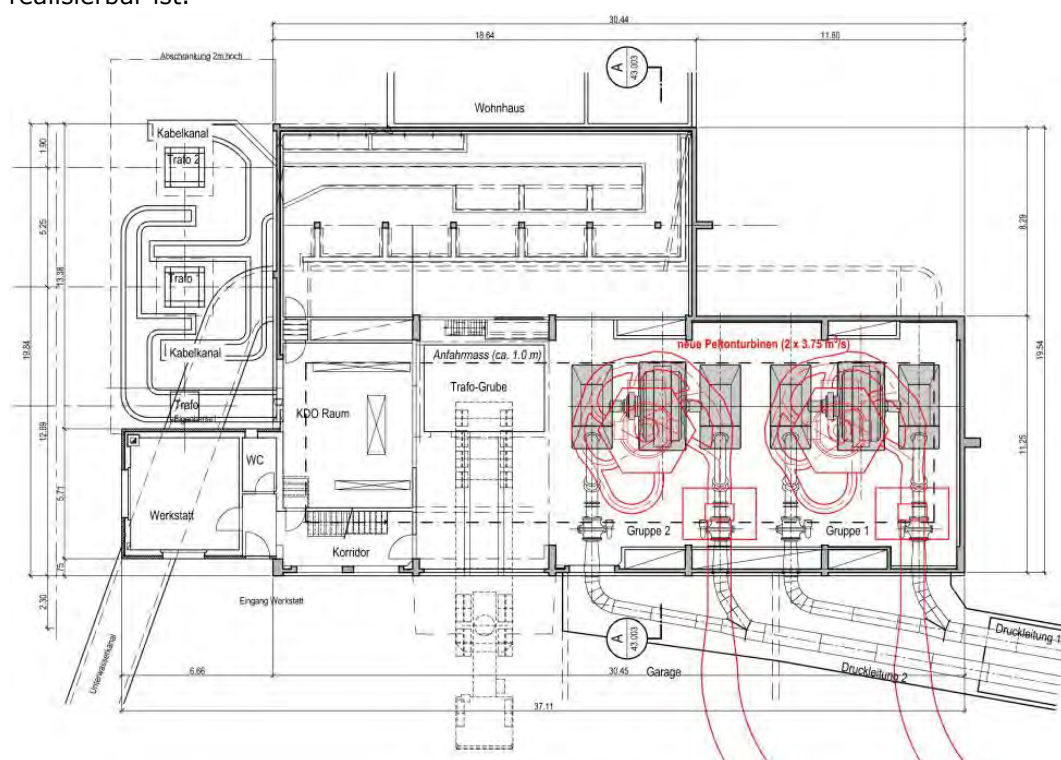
Grundriss der geplanten Erweiterung des Maschinenhaus Bisisthal.
